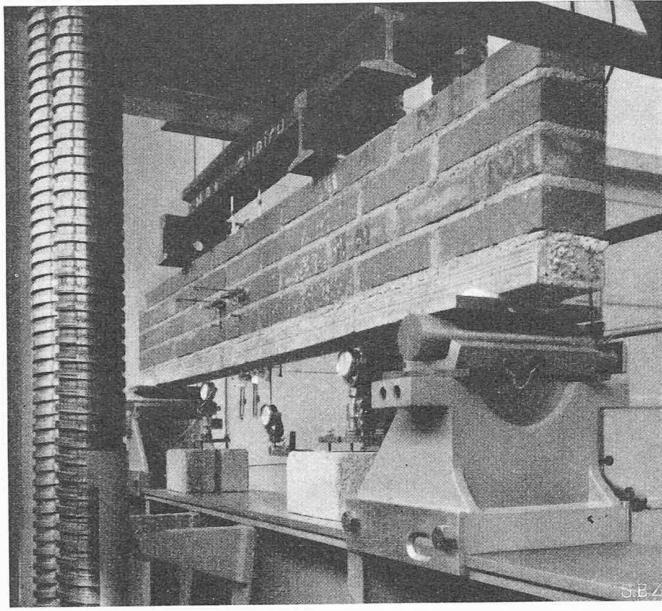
Belastungsversuch an einem vorgespannten Stahltonbrett mit Uebermauerung
